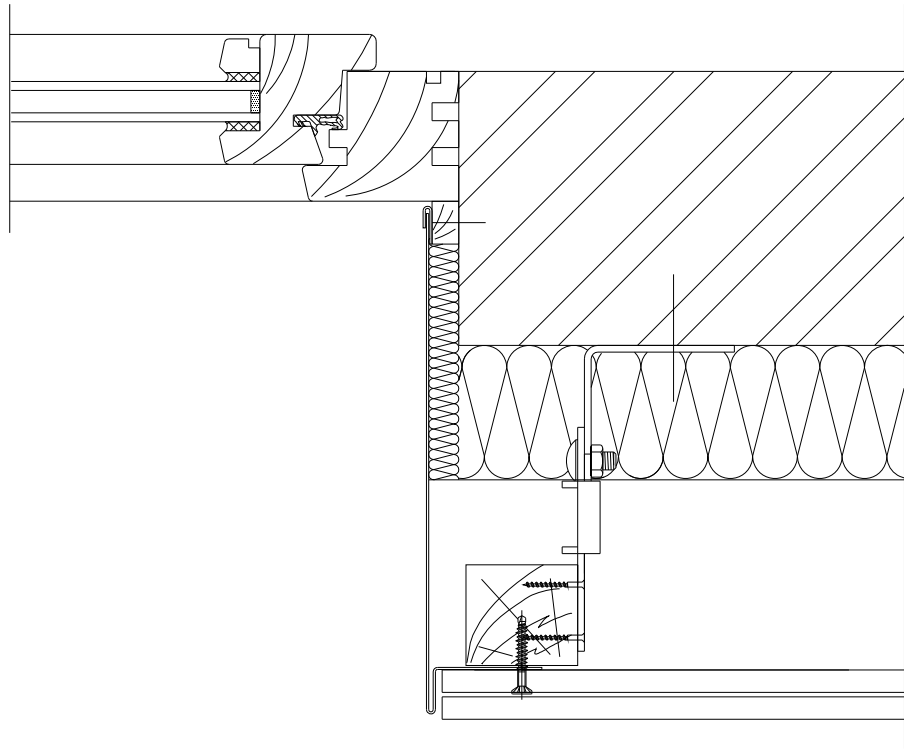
Encadrement de fenêtre (coupe sur tableau)
